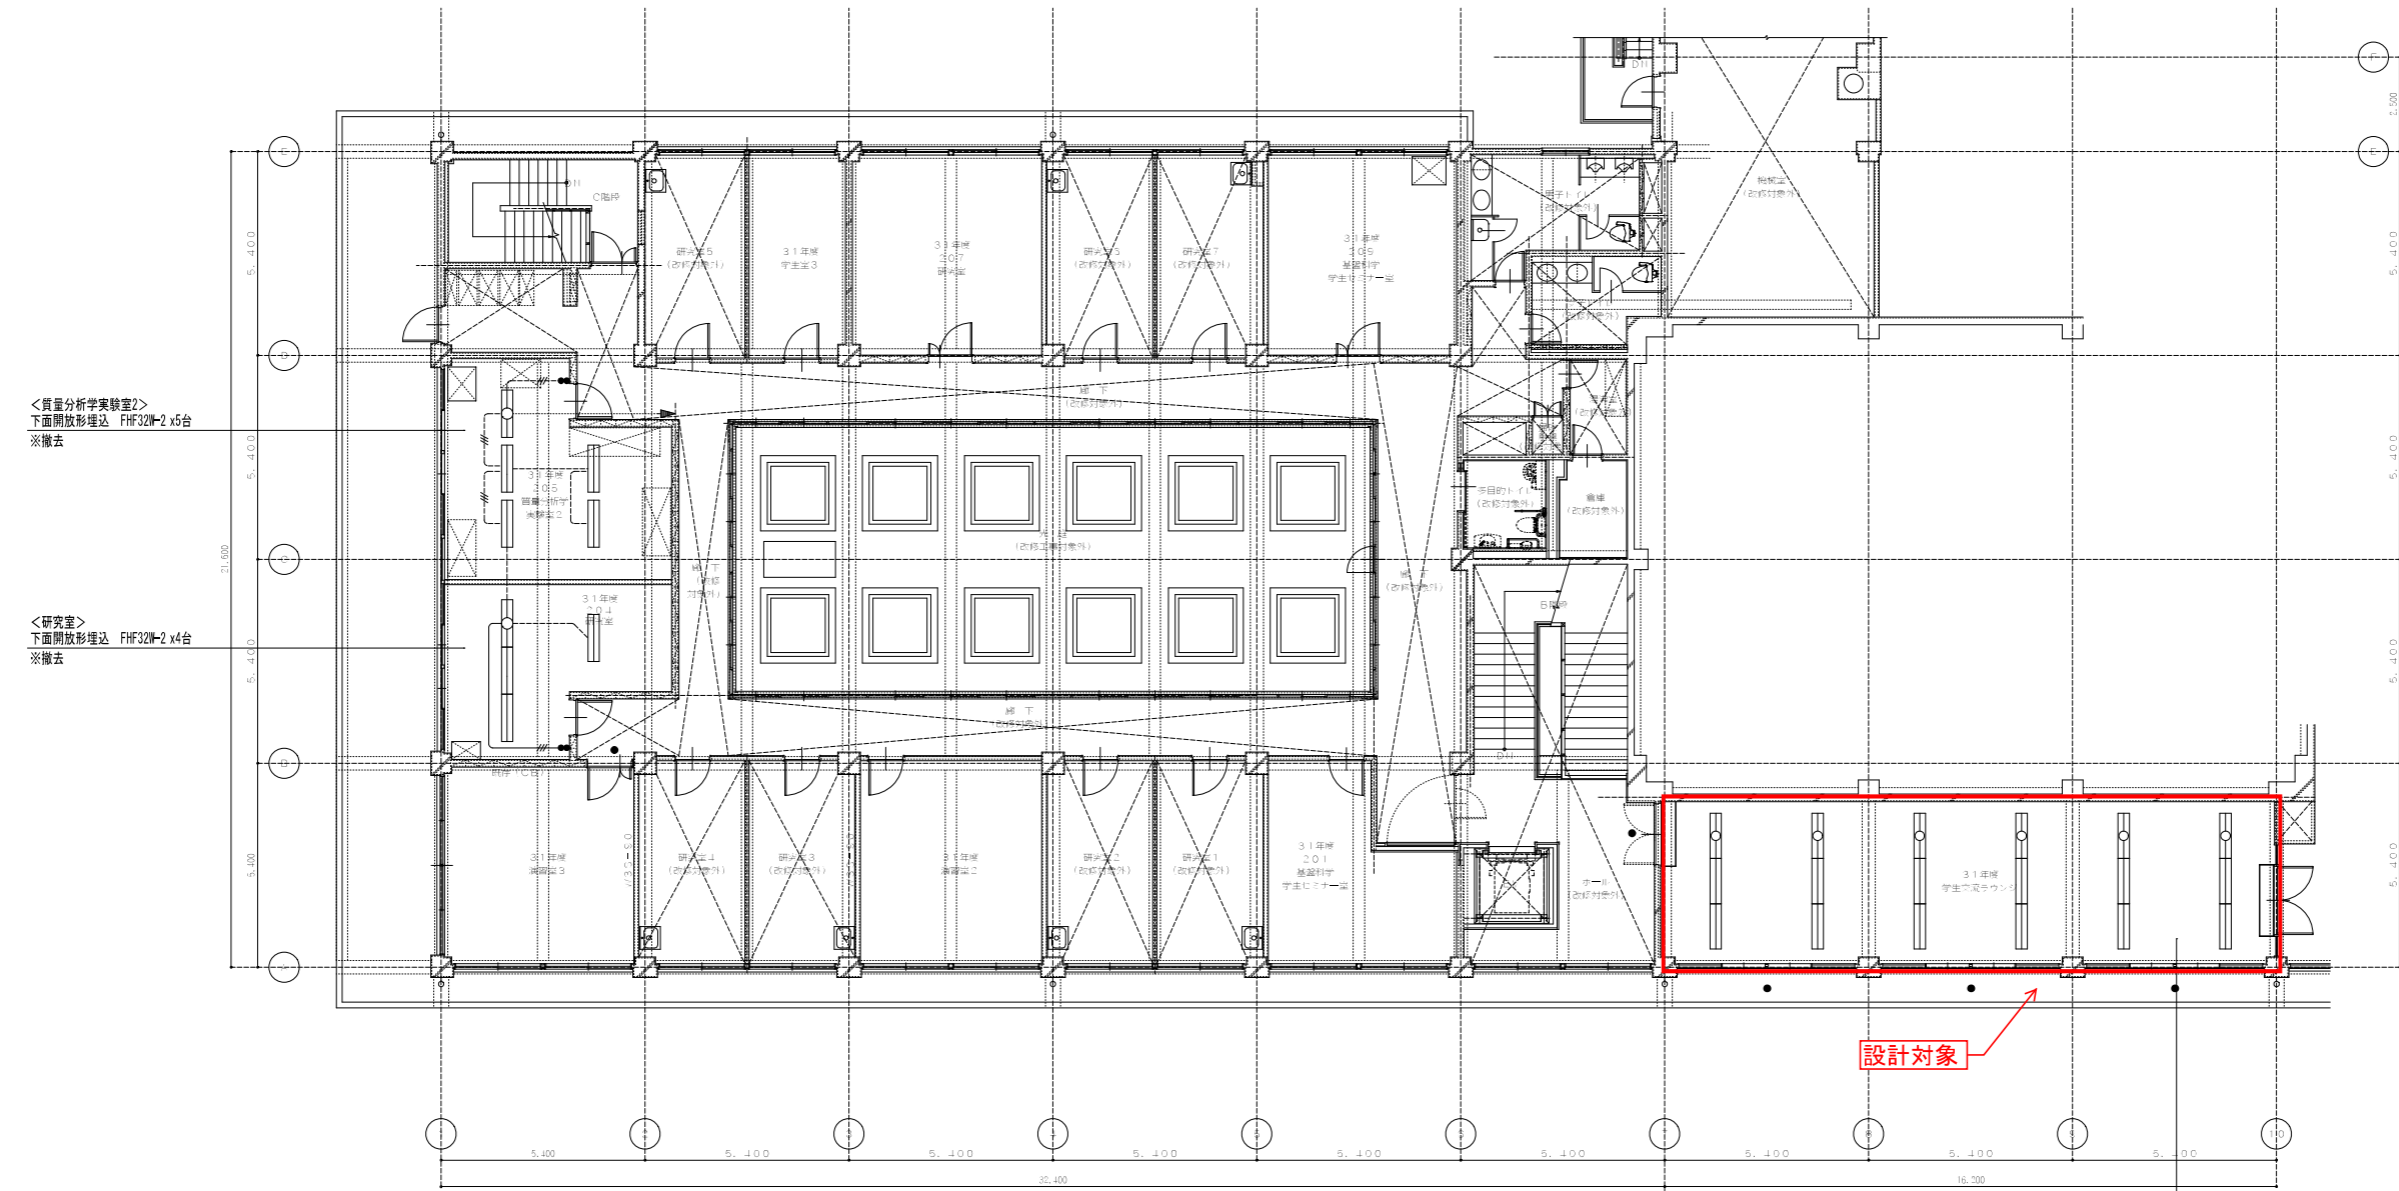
自動火災報知設備2層平面図	1/100	製作 変更
